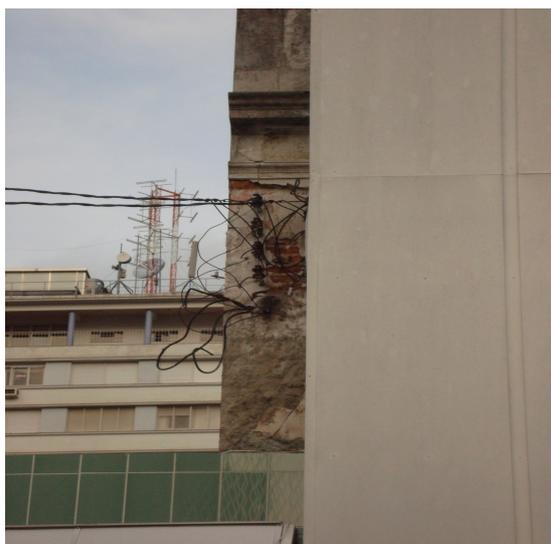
Rua Andrade Neves n. 1848 (detalhe)
